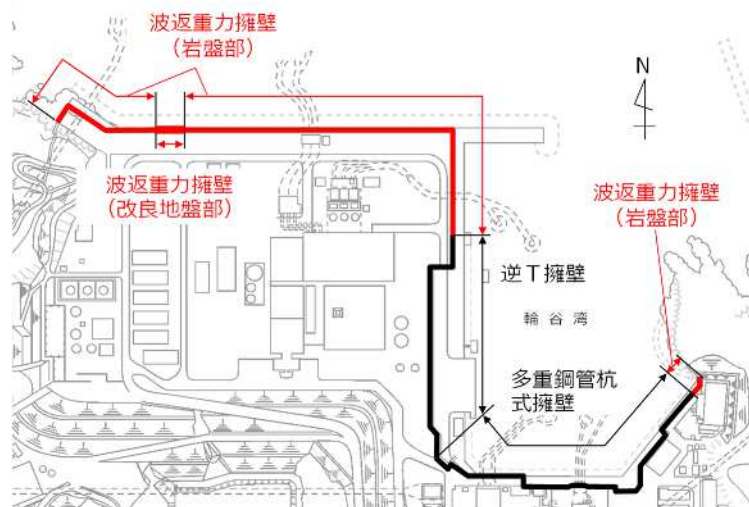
防波壁（波返重力擁壁）の平面配置図
